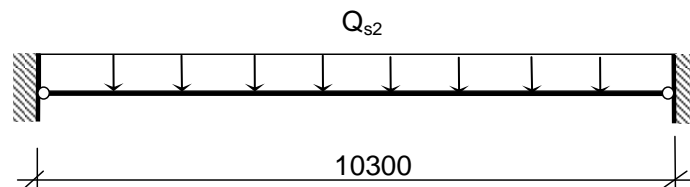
Розрахункова схема залізобетонної плити перекриття ПМ-1 для розрахунку несучої здатності
